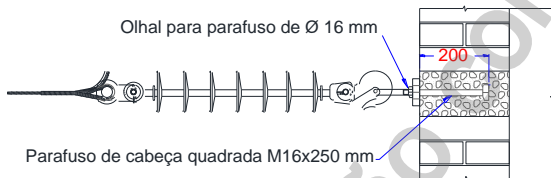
Detalhes Construtivos em Subestações - Fixação da Cadeia de Isoladores (1/4)
